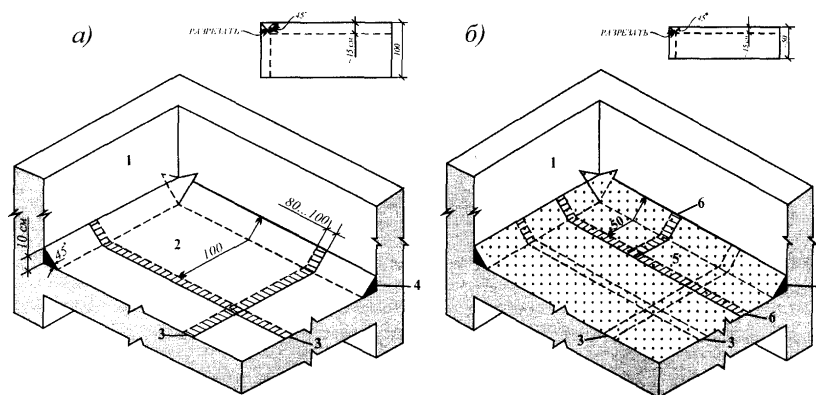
Раскладка и раскрой Акваизола (а - нижнего слоя, б - верхнего) при устройстве основного кровельного ковра в углу парапета
